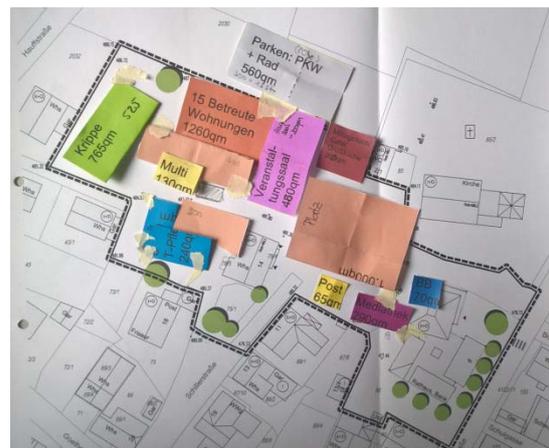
Variante: Mehrere hierarchisierte Plätze, Erhalt des Kellerhauses und des „Winkels“, Parken nördlich des Gebietes (erstellt: planbar³)
